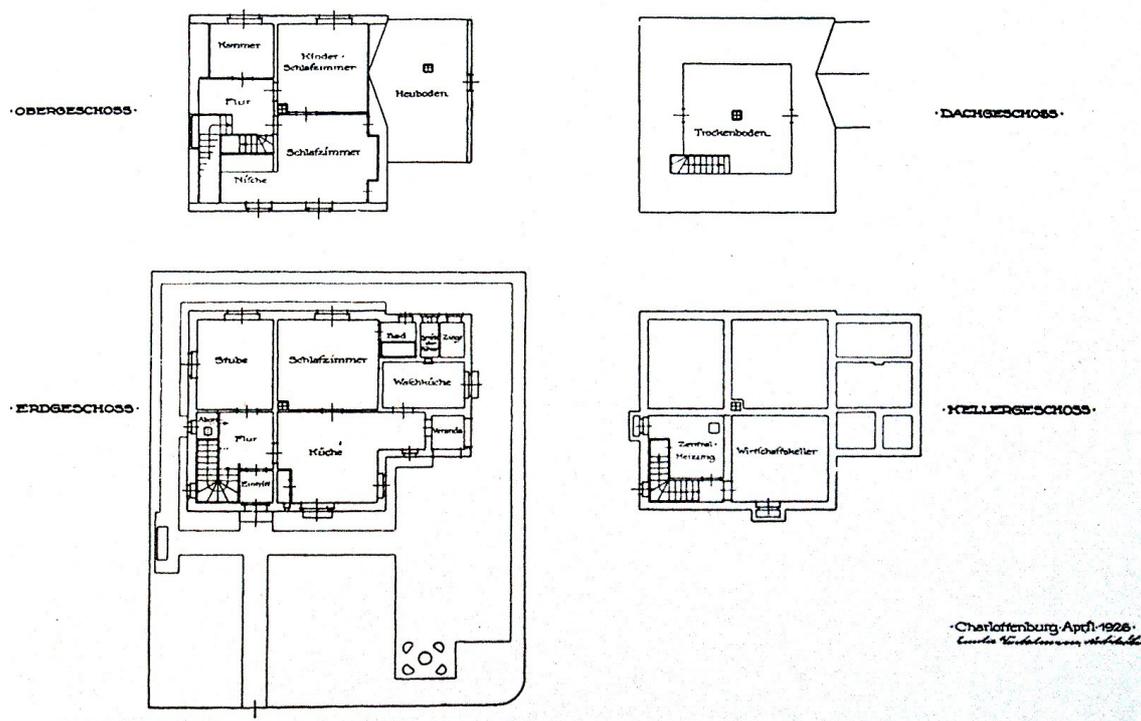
Haus eines Mittelständlers (Grundriss)
